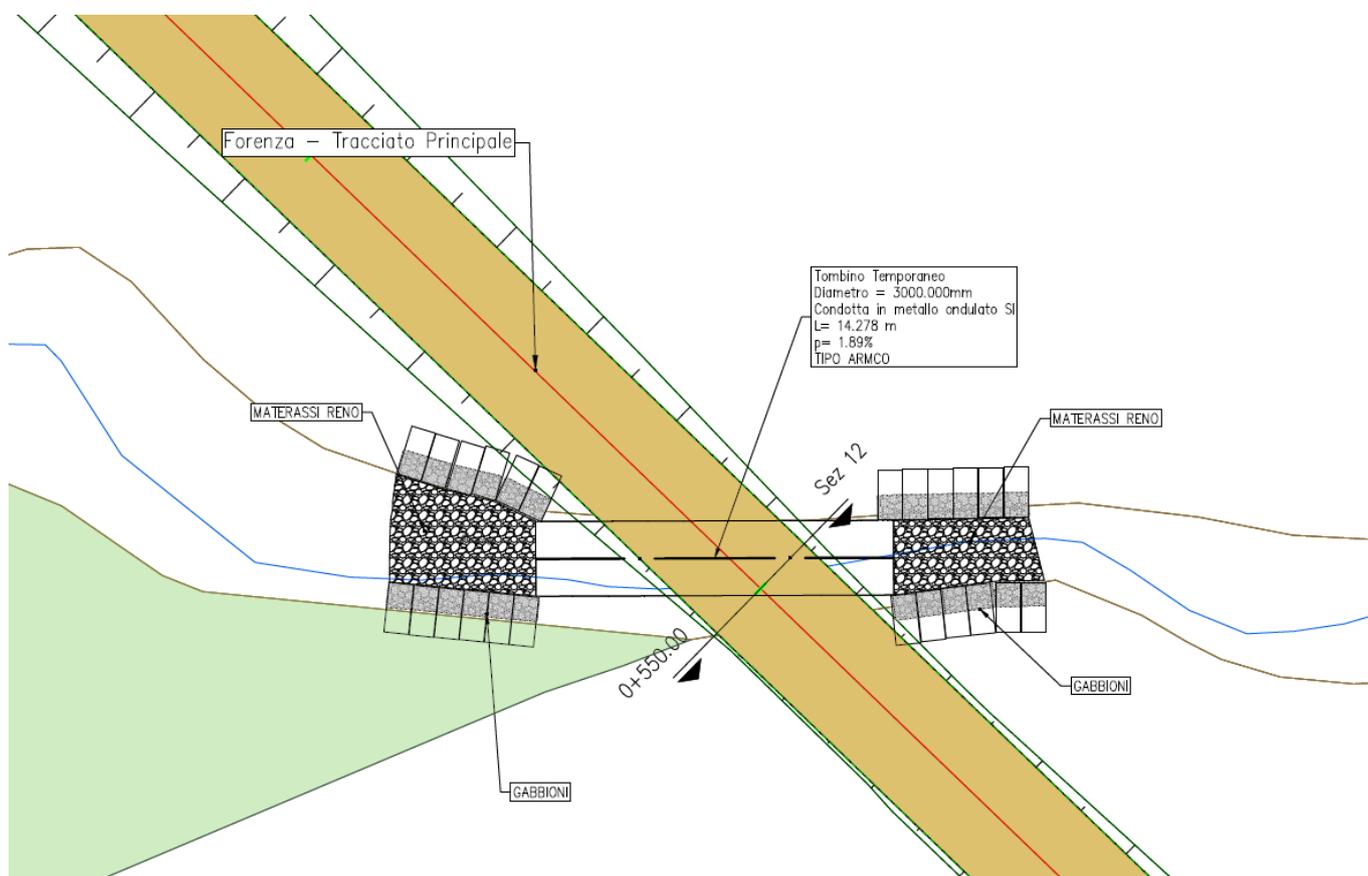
Dettaglio risoluzione interferenza- viabilità di cantiere (F0626AT05A - A.16.a.13.1 - a.14 - Planimetrie stradali e profili longitudinali)
